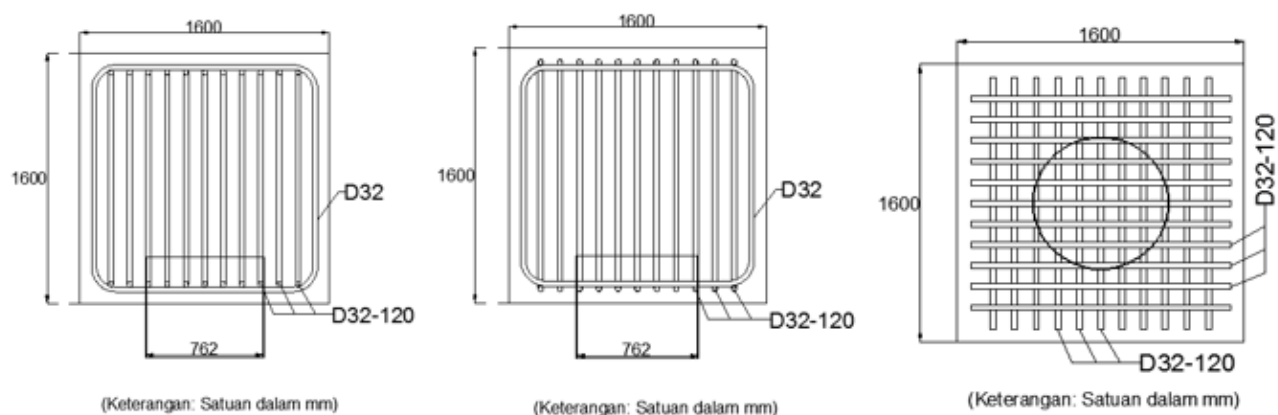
Ilustrasi Potongan *Pile Cap Loading Platform* (Melintang - Memanjang - Tampak Atas)
